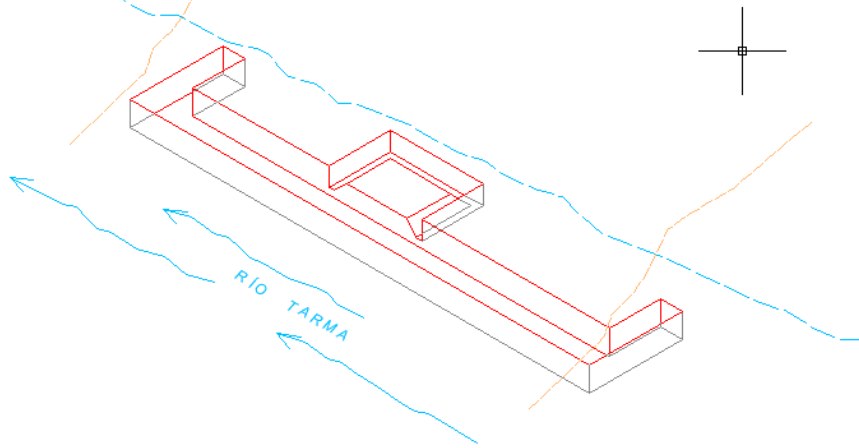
Excavación de zanjas para platea de cimentación (lecho del río)
